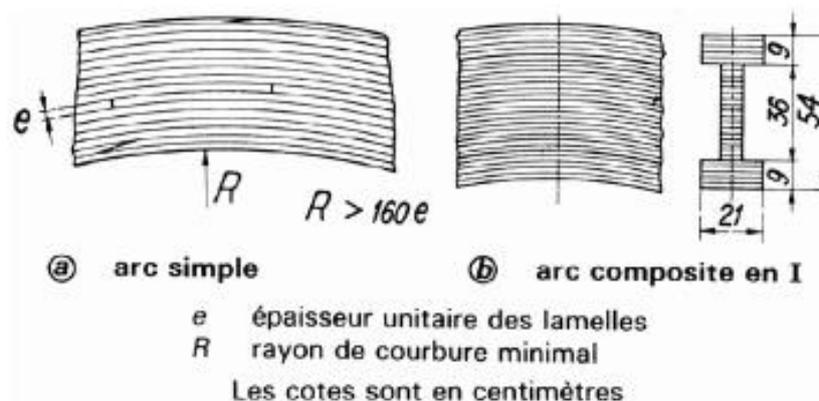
Arc lamellé (fabrication par encollage sur cintre)
